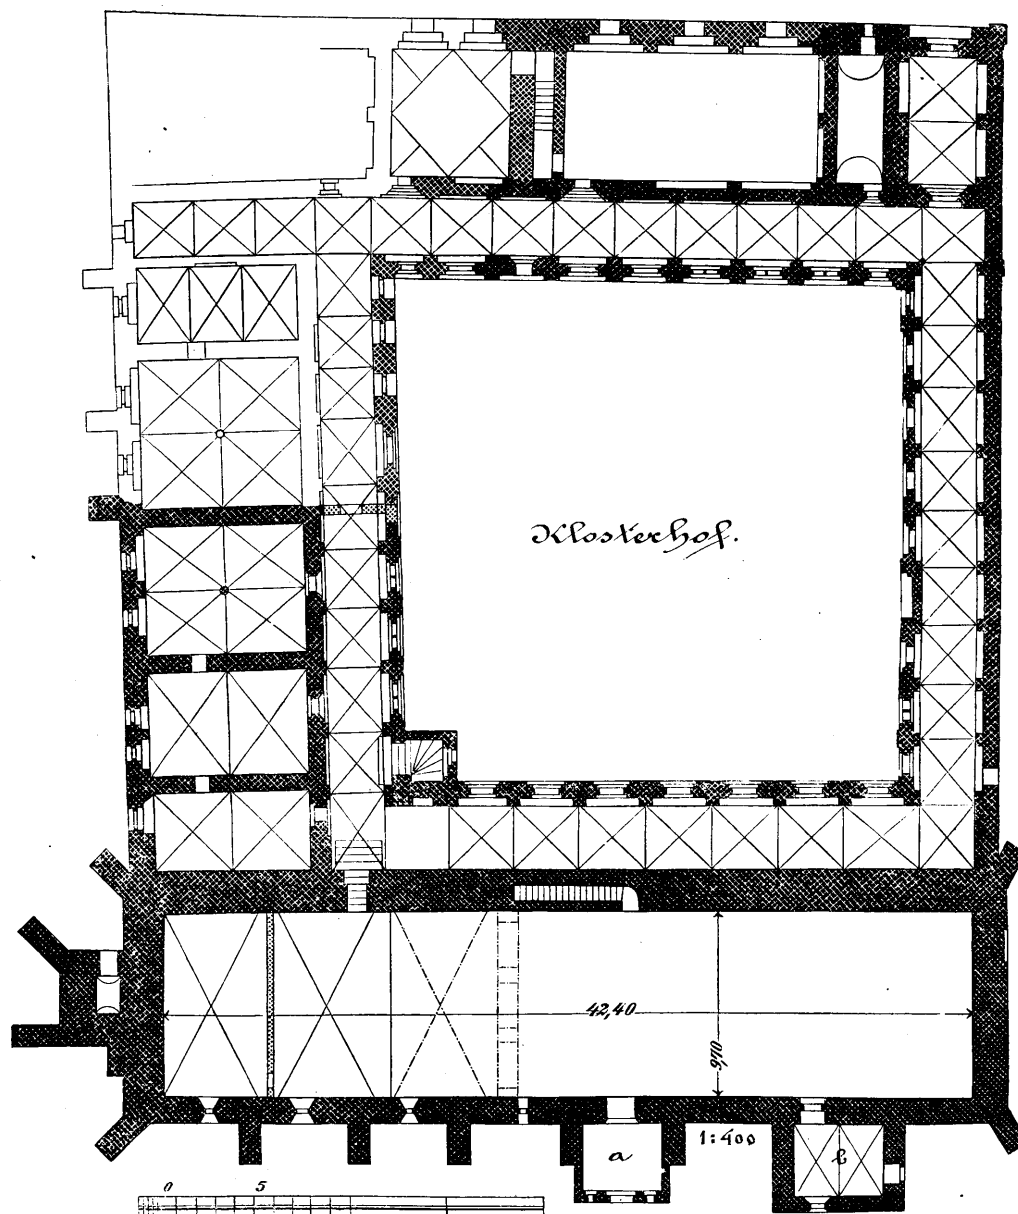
Grundriss des Klosters Zarnowitz.
